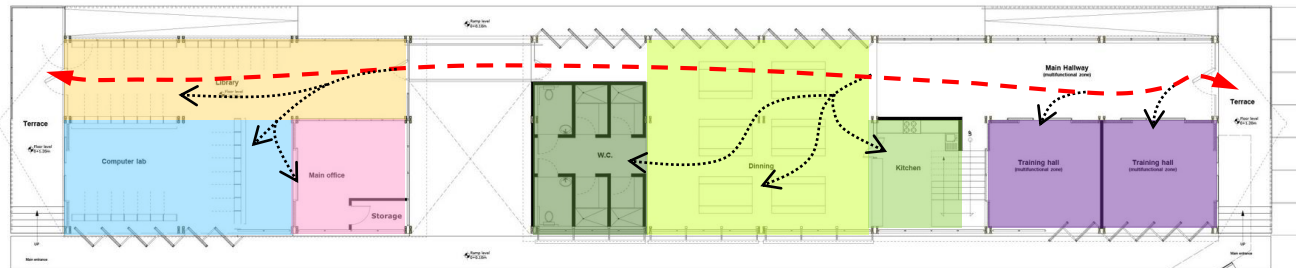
Planta do primeiro pavimento. Fonte: ArchDaily.
